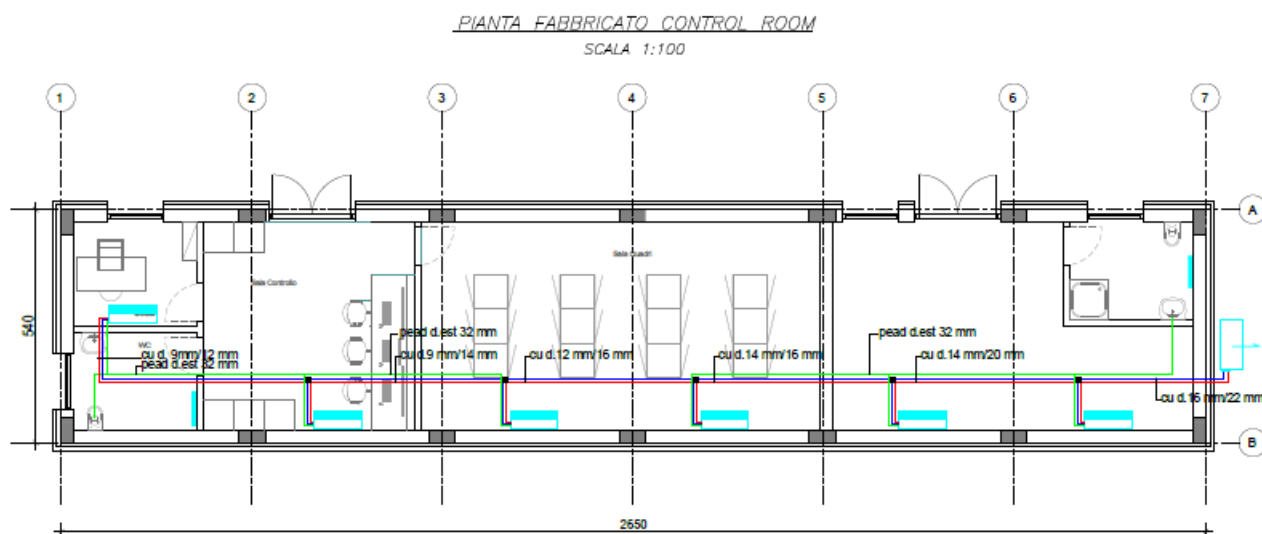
Stralcio planimetria con indicazione degli impianti a funzionamento continuo
